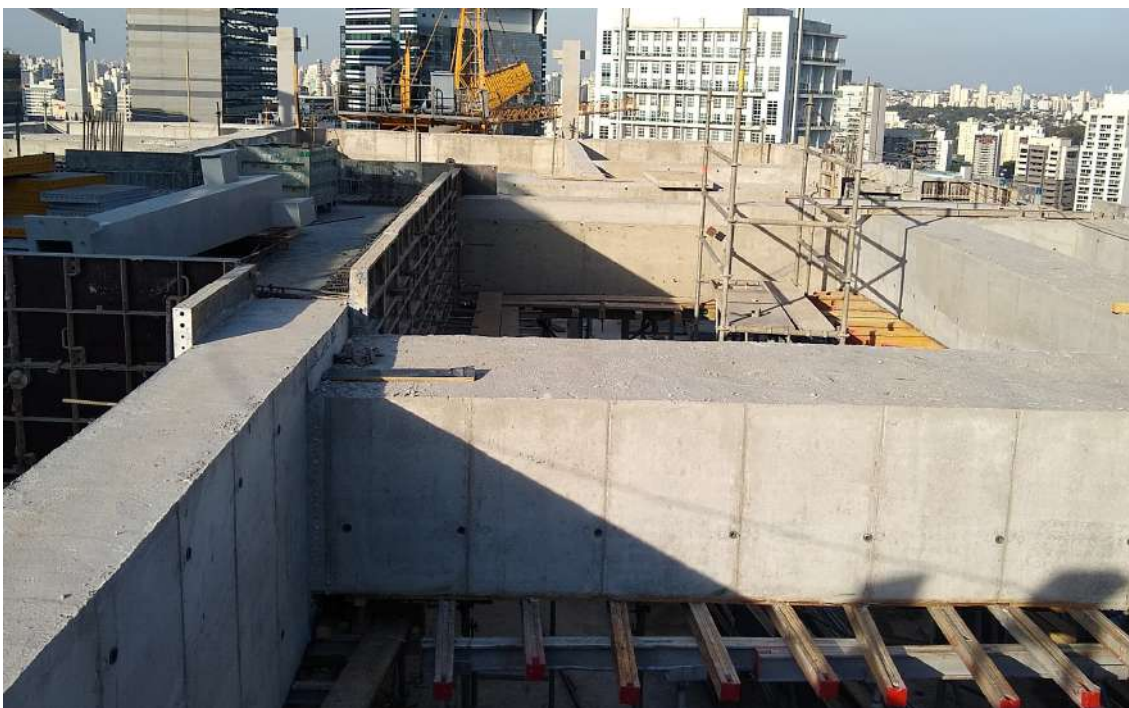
Obra Parque da Cidade Gleba G - Vigas com desforma Tekko® SH - 40 kN/m²
